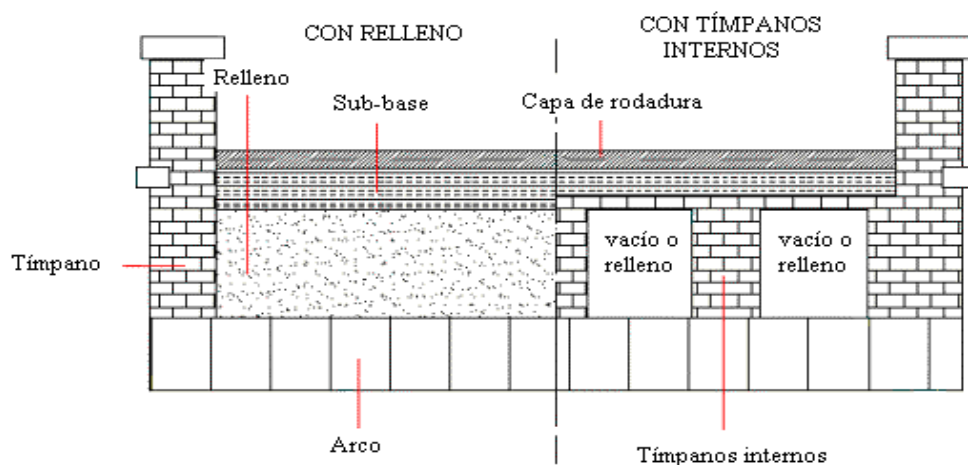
Sección transversal típica de un puente con bóveda de arco.
